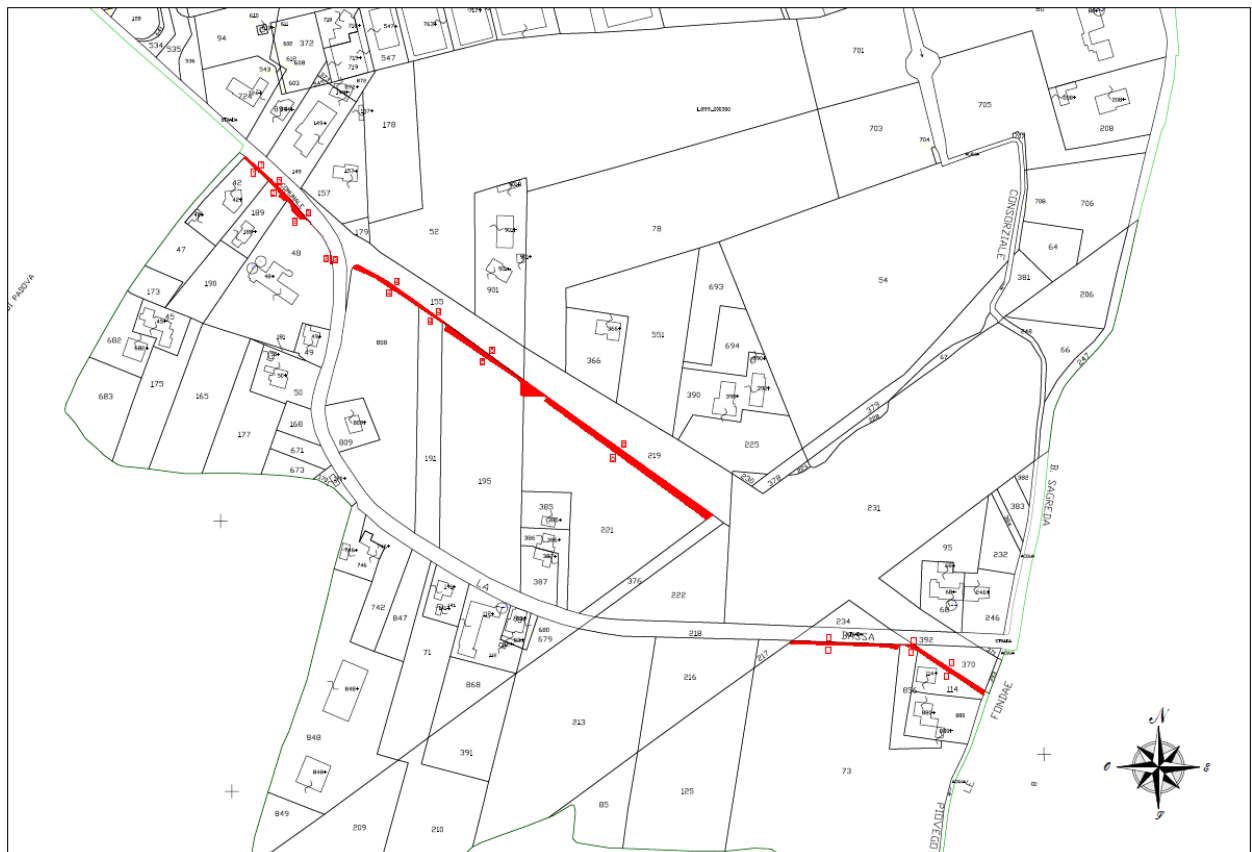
Planimetria generale di esproprio (scala 1:2.000)
